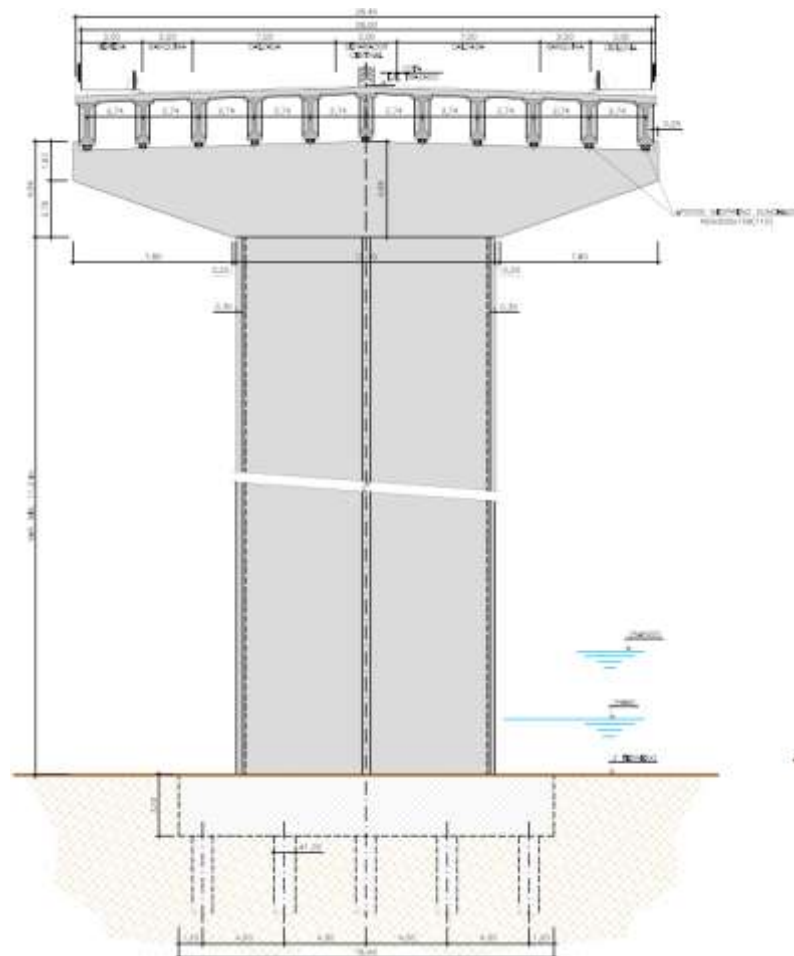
Alzado pila cajón Tipo 3 para apoyo de tablero de calzada doble.
